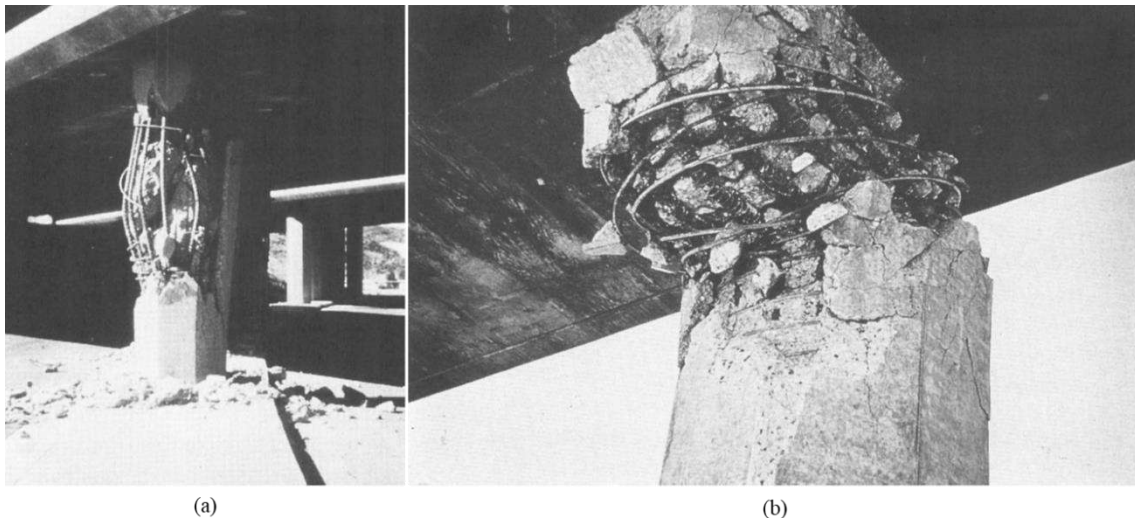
(a) Falla por corte en tramo central de la columna. (b) Falla por corte en la rótula plástica (Priestley et al., 1996).
